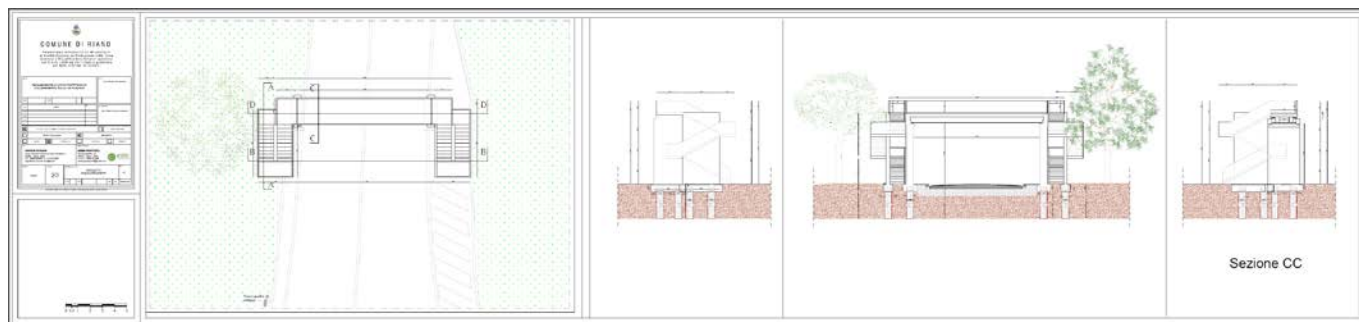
A23: pianta, prospetto e sezioni A-A/B-B in scala 1:100.
